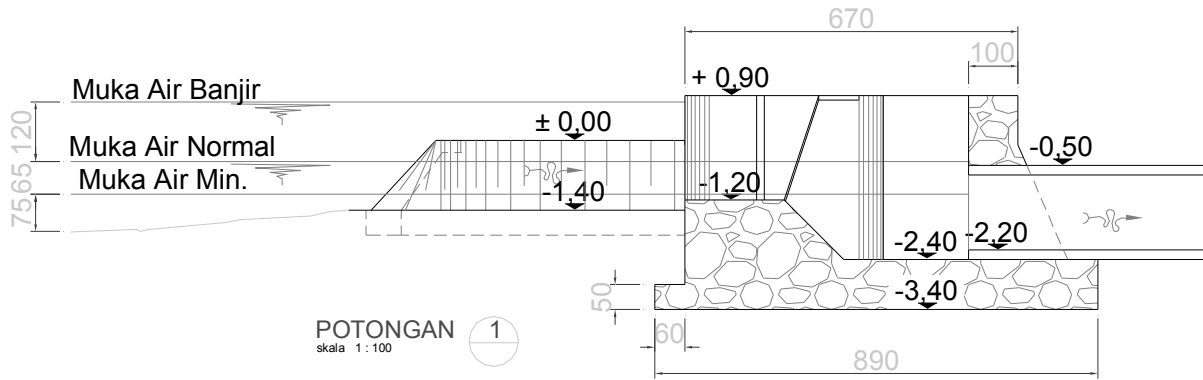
Potongan 2 bangunan pengambilan bebas dengan pintu air
